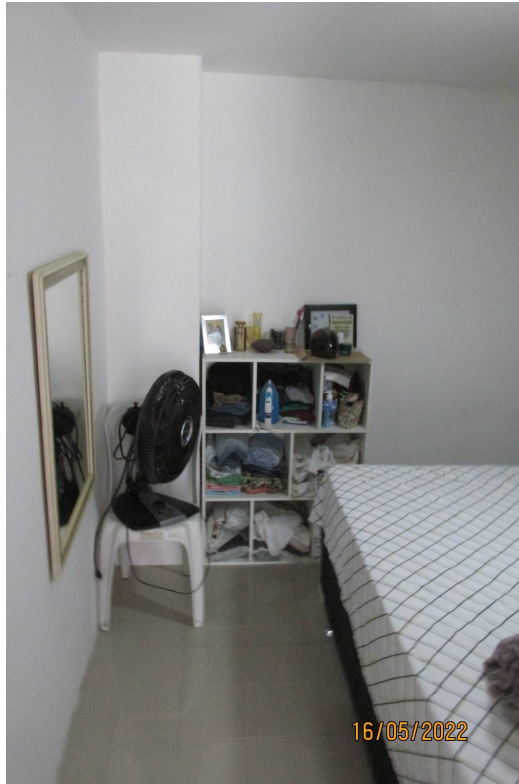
Vista do dormitório. Observar acabamento de piso, paredes e teto e ausência de abertura destinada a ventilação e iluminação.
